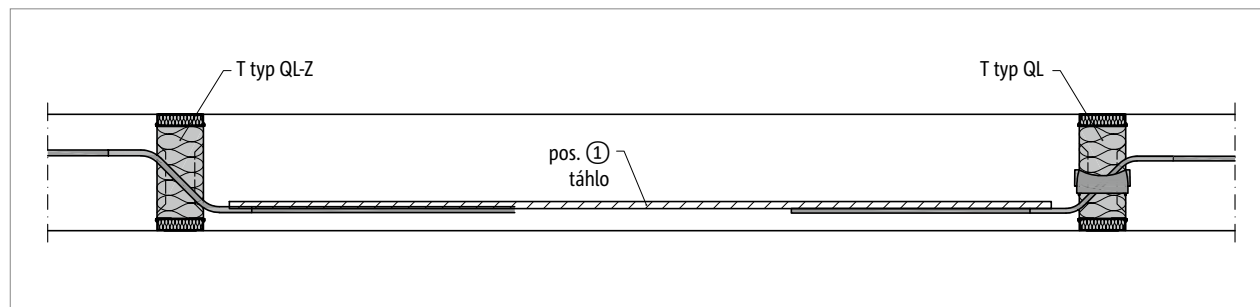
Schöck Isokorb® T typ QLN-Z, QLN, ZL: Železobetonová deska vyztužená v jednom směru
